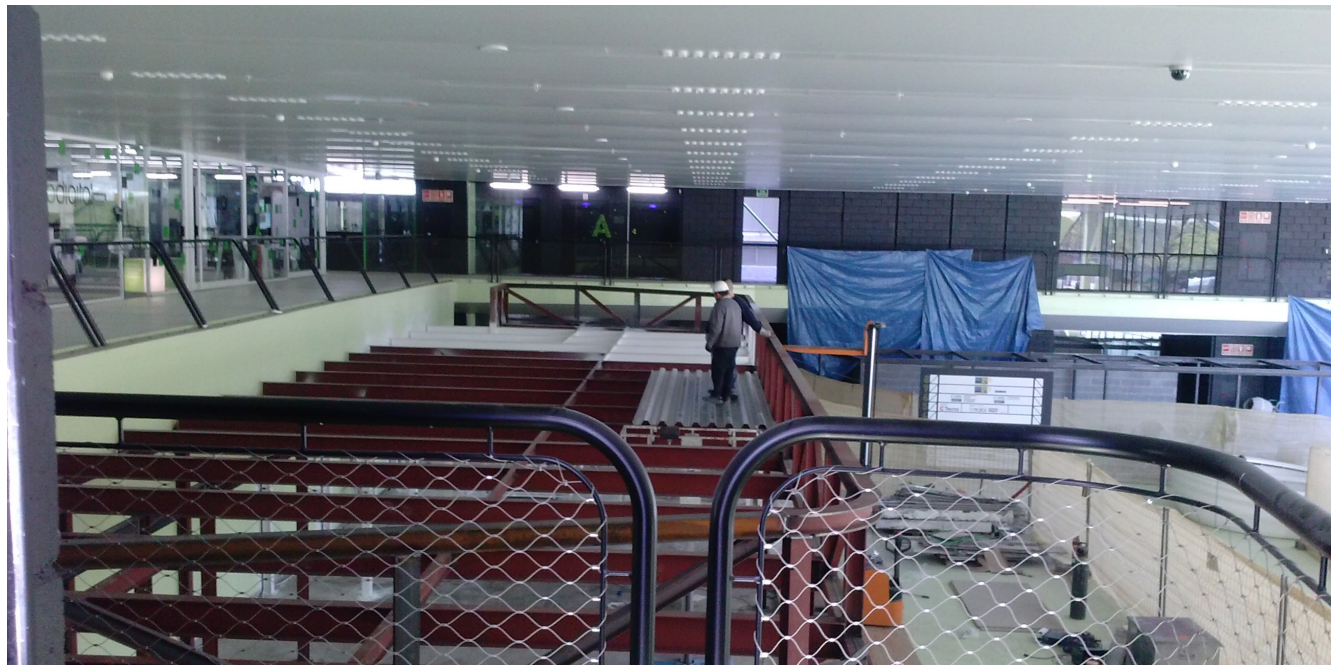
(sup. izq.) : Planta Baja libre hasta 2014, zona usada para *breakfast*. Edificio Media-Tic.
